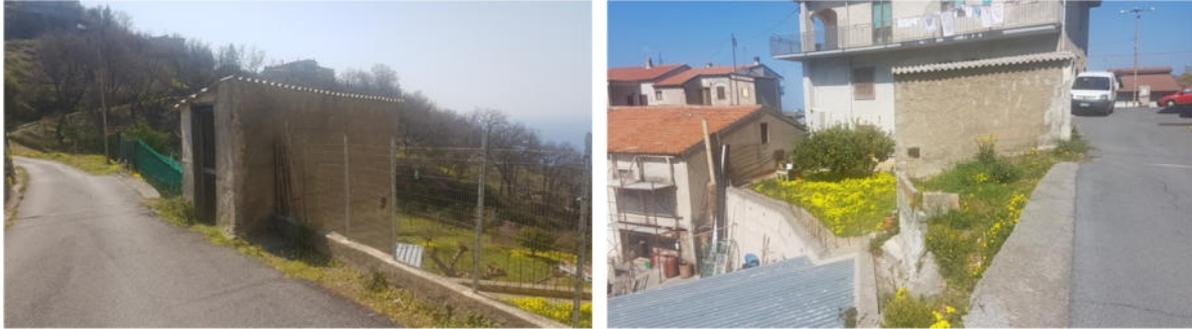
/4 – Deposito in blocchi di cemento
